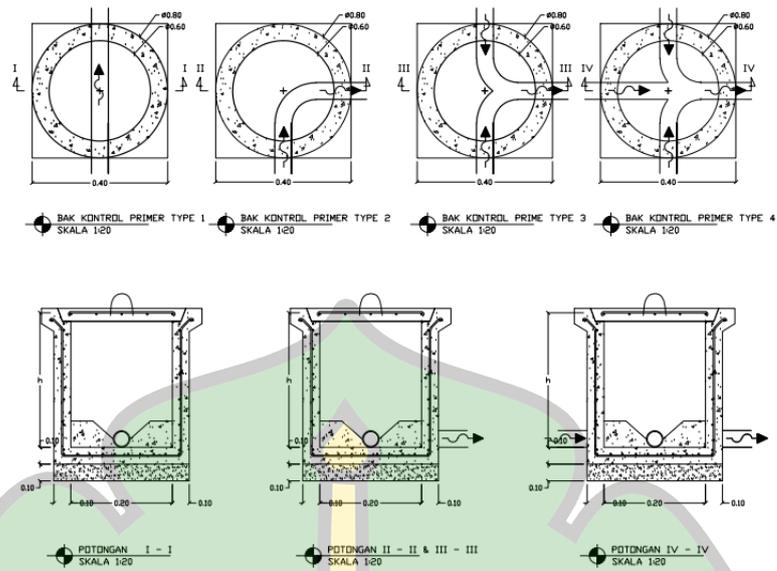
Detailed Engineering Design (DED) Pemipaan Primer dan SR
